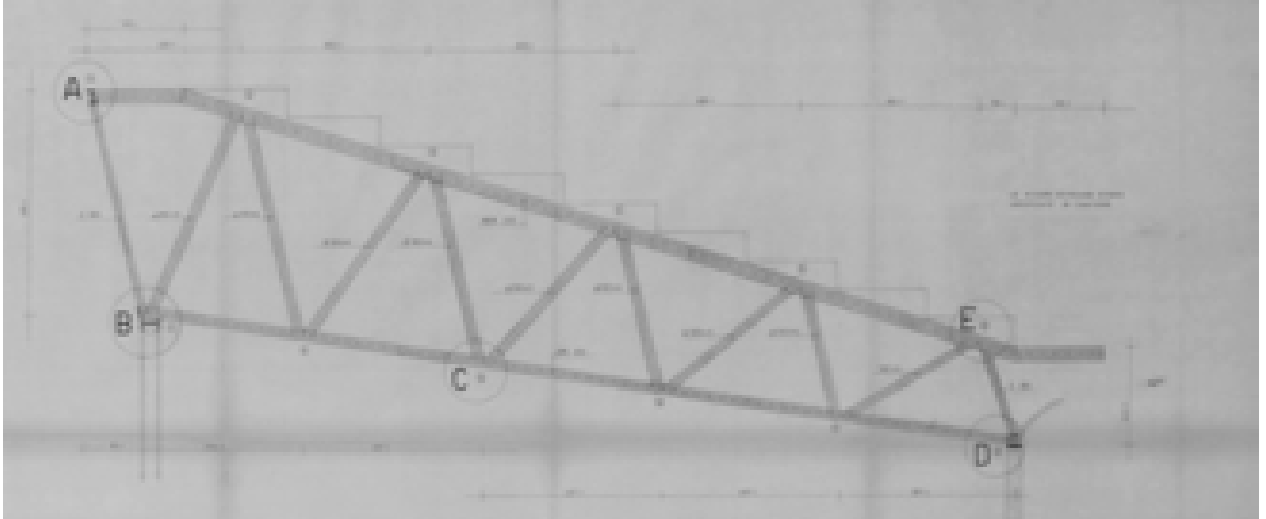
Progetto esecutivo della trave reticolare, gennaio 1987 (AABS-179)
